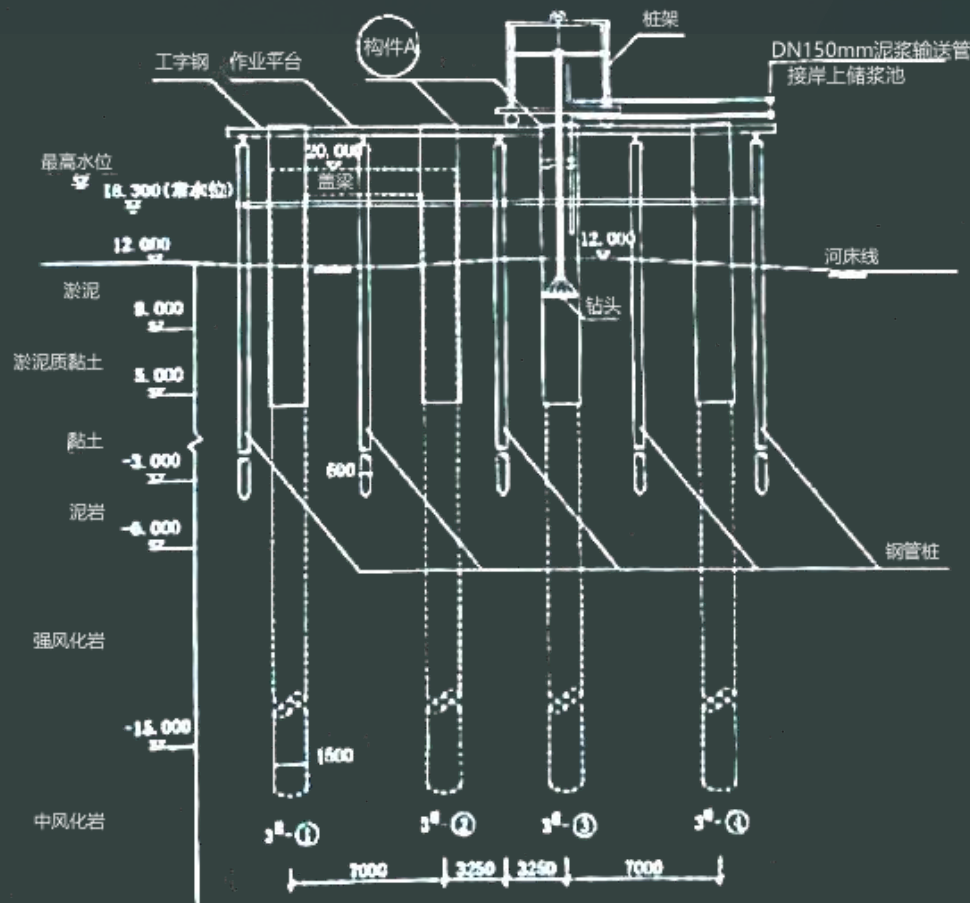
3#墩水上作业平台及桩基施工横断面布置示意图
